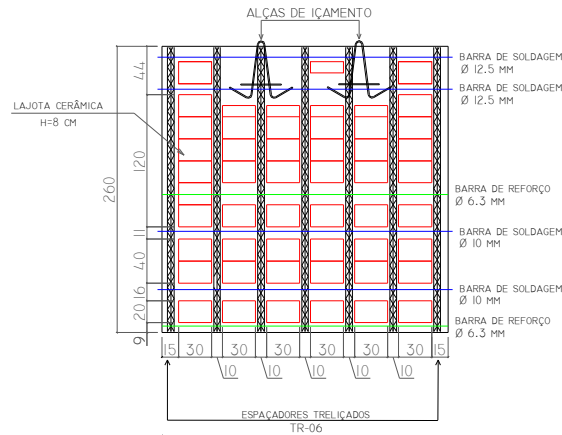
Planta com os elementos constituintes do painel sem vão de porta ou janela edificações habitacionais de até 05 pavimentos
